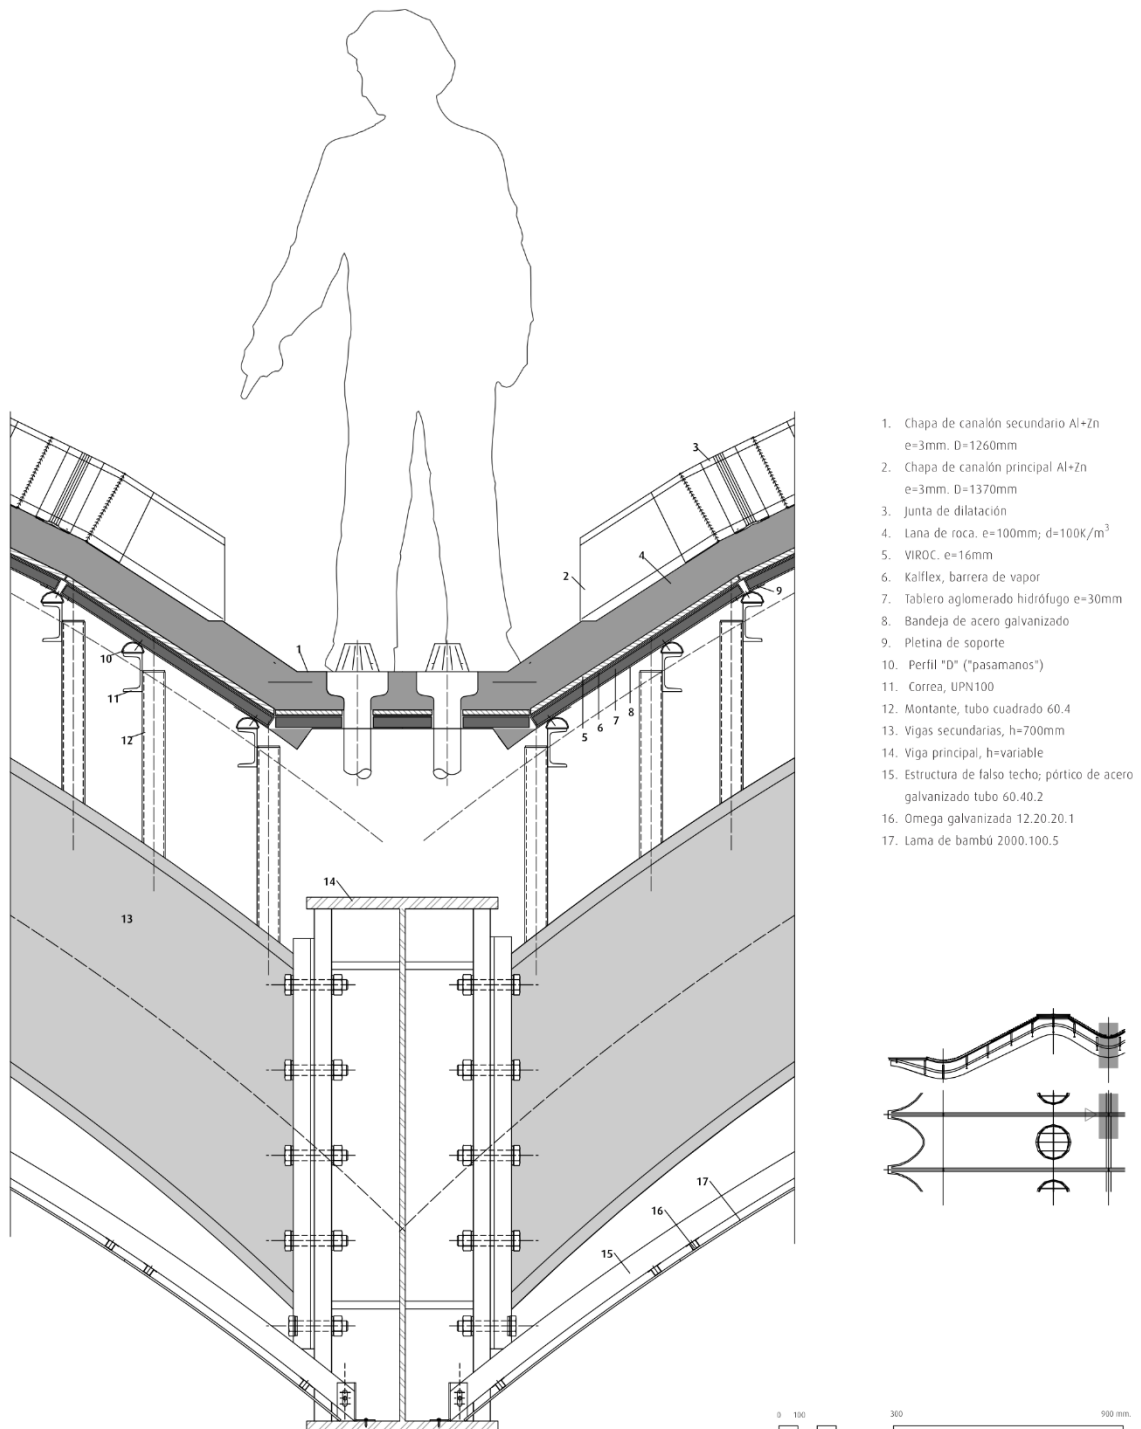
| Detalle constructivo de la cubierta. (TC Cuadernos)
